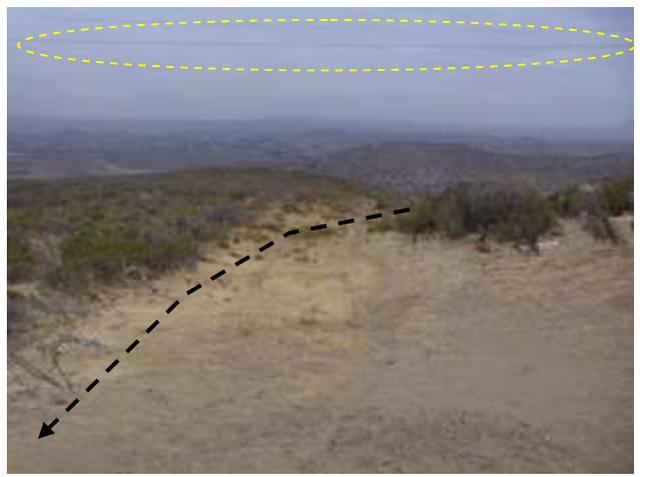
Traza de los ductos por picada desprovista de vegetación interfiriendo con línea eléctrica. Foto mirando al Sur.
